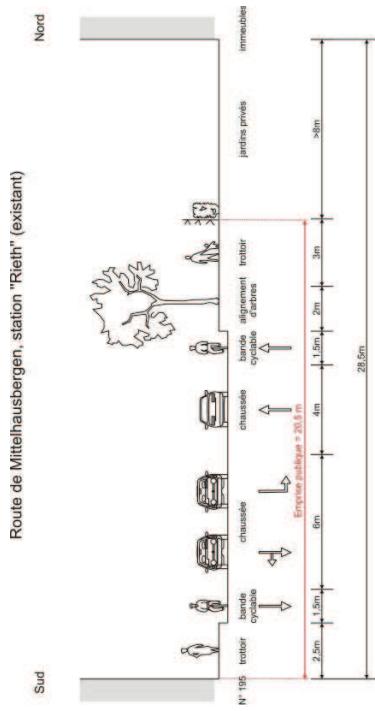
Situation existante. Coupe d'insertion sur la rue de Mittelhausbergen (variante 3)
